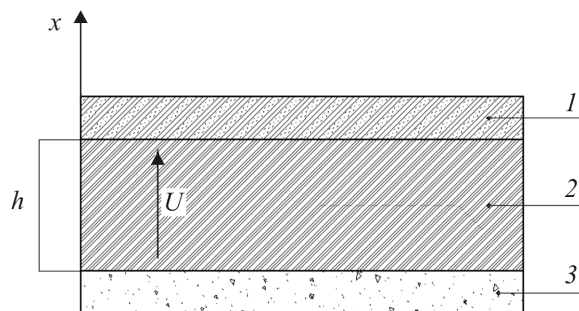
Расчетная схема задачи фильтрации: 1 – граница дренируемого объема грунта; 2 – подстилающий грунт; 3 – уровень грунтовых вод; h – высота столбика грунта
